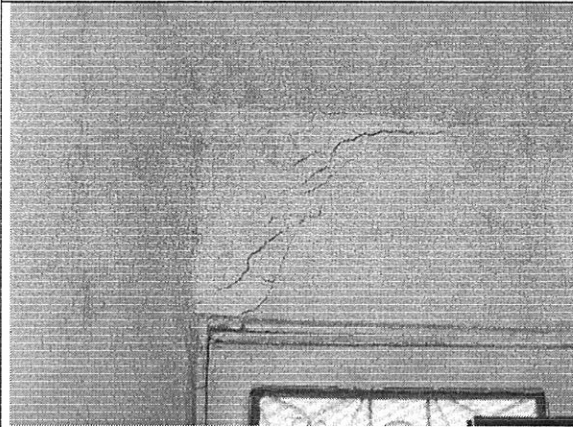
Agrietamiento en diagonal en muro del primer piso
